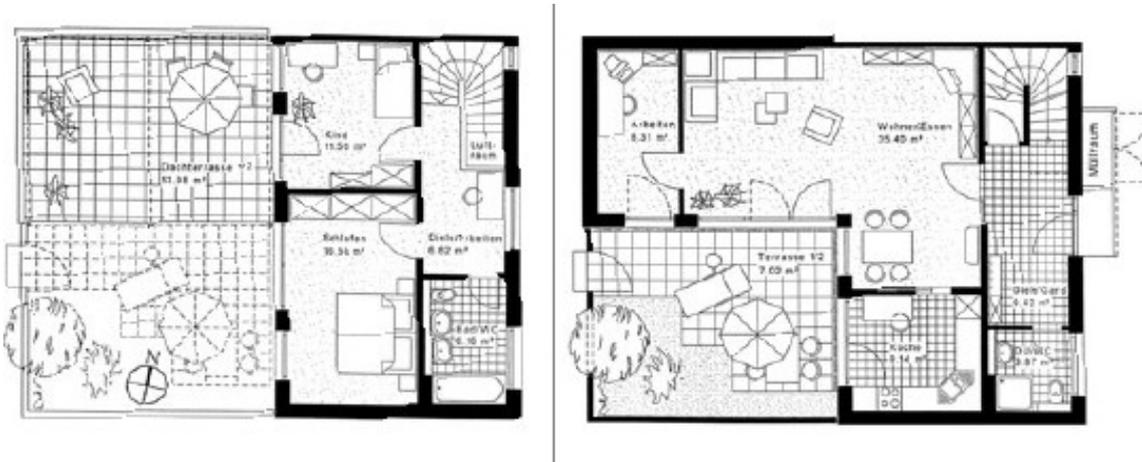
Bauabschnitt am Ackermannbogen entstanden zwölf Atriumhäuser, als eine Wohnform mit variabler und individueller Grundrissorganisation von 3-, 4- und 5-Zimmer-Haustypen. Ein geschützter Innenhof bietet einen sehr privaten Freibereich. (Quelle: Schulze und Partner)
